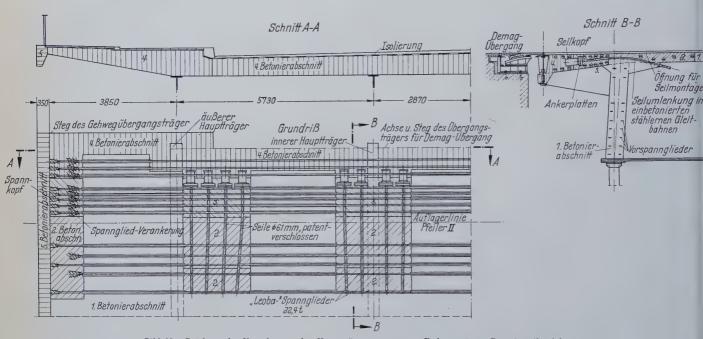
Brückenende, Verankerung der Hauptträgervorspannung, Endquerträger, Betonierreihenfolge
